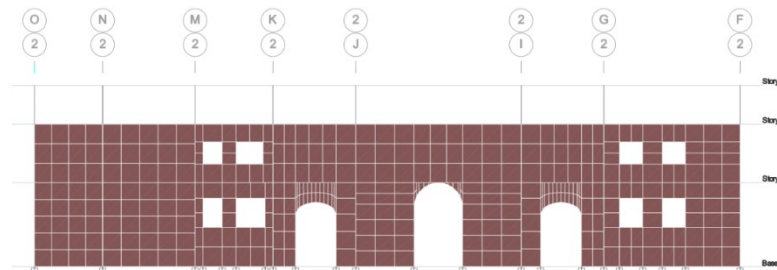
MEF – Elevación del eje 2: Fachada principal. Fuente: Propia.
